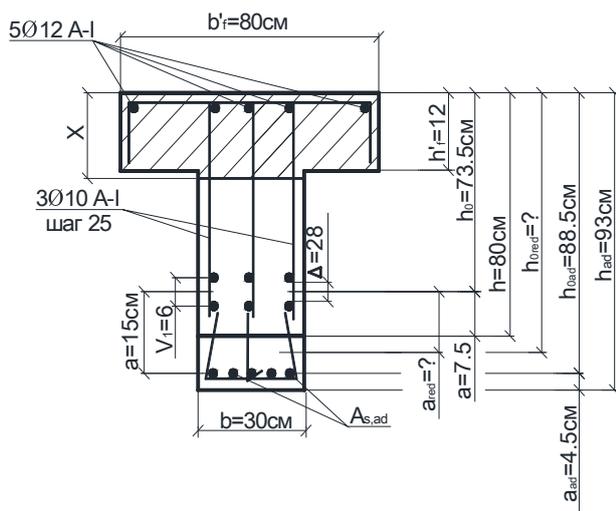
Расчетная схема усиления элемента таврового профиля.
